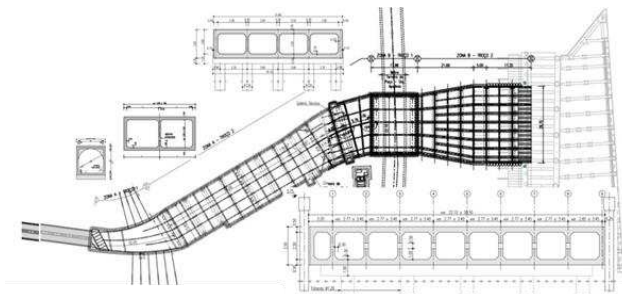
Ouvrage de restitution (TM5) – plan et coupes-types.
